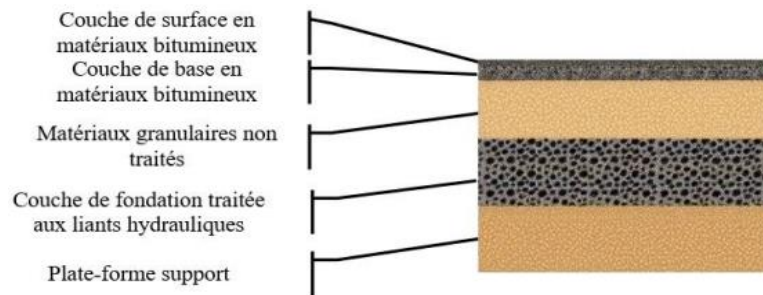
Structure d'une chaussée inverse (Nguyen, 2008).
